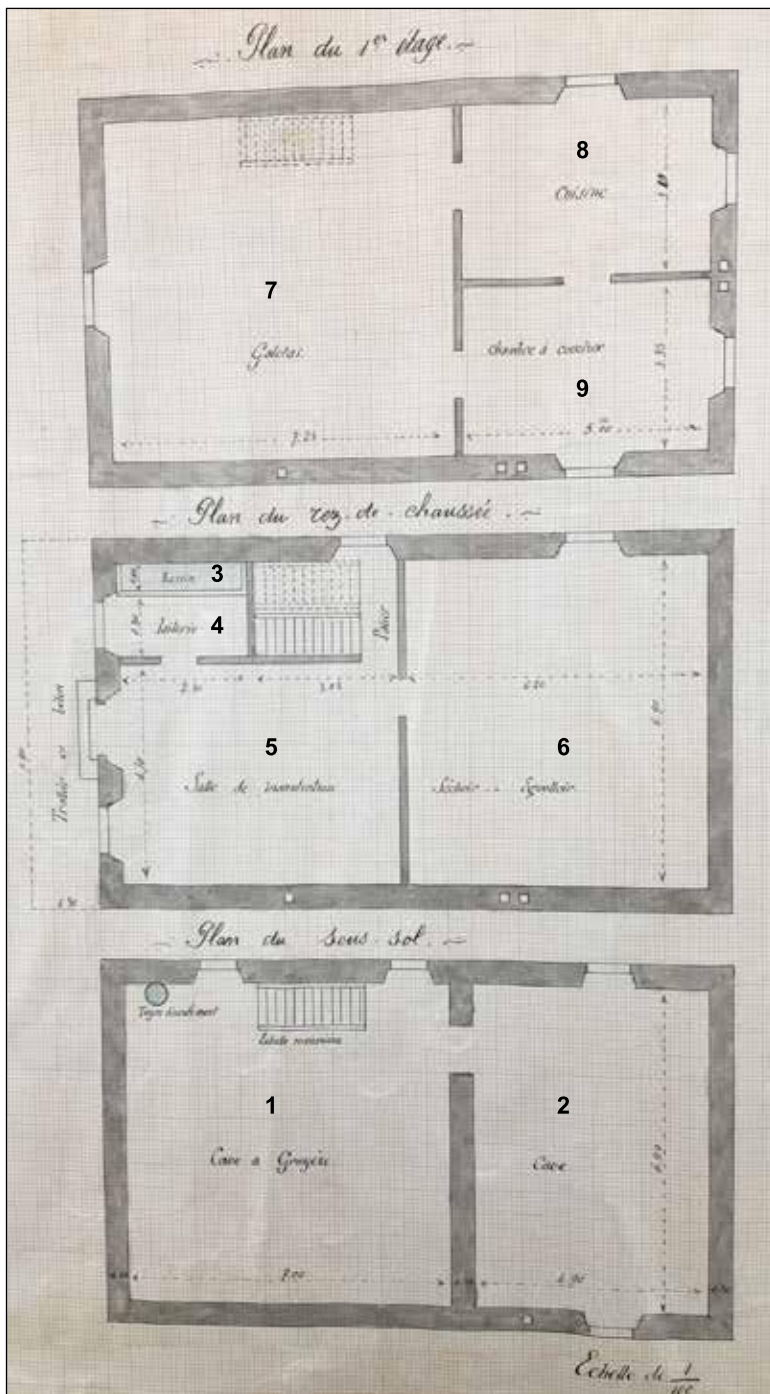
Plan de réfection et d'agrandissement de la fruitière de Ceillac (1913- 1914), AD05 7 M 88. Sous-sol, 1 : cave à gruyère, 2 : cave. Rez-de-Chaussée, 3 : bassin, 4 : laiterie, 5 : salle de manutention, 6 : séchoir-égouttoir. Premier étage, 7 : galetas, 8 : cuisine, 9 : chambre à coucher.
